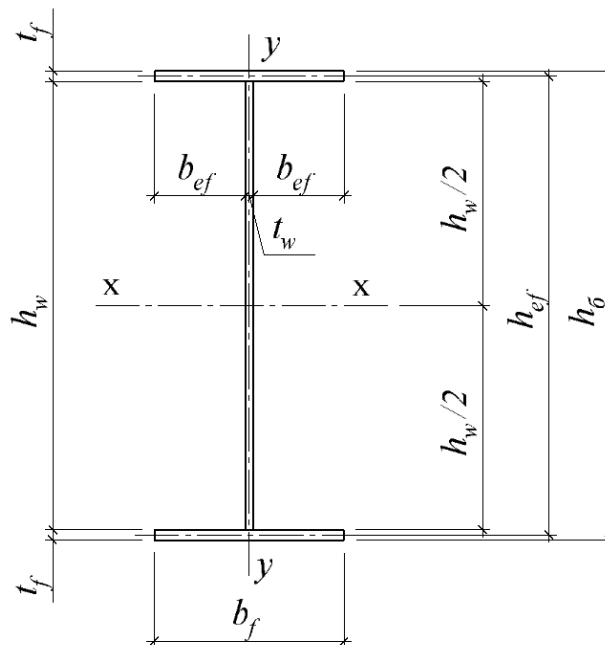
Поперечное сечение сварной двутавровой балки с двумя осями симметрии
